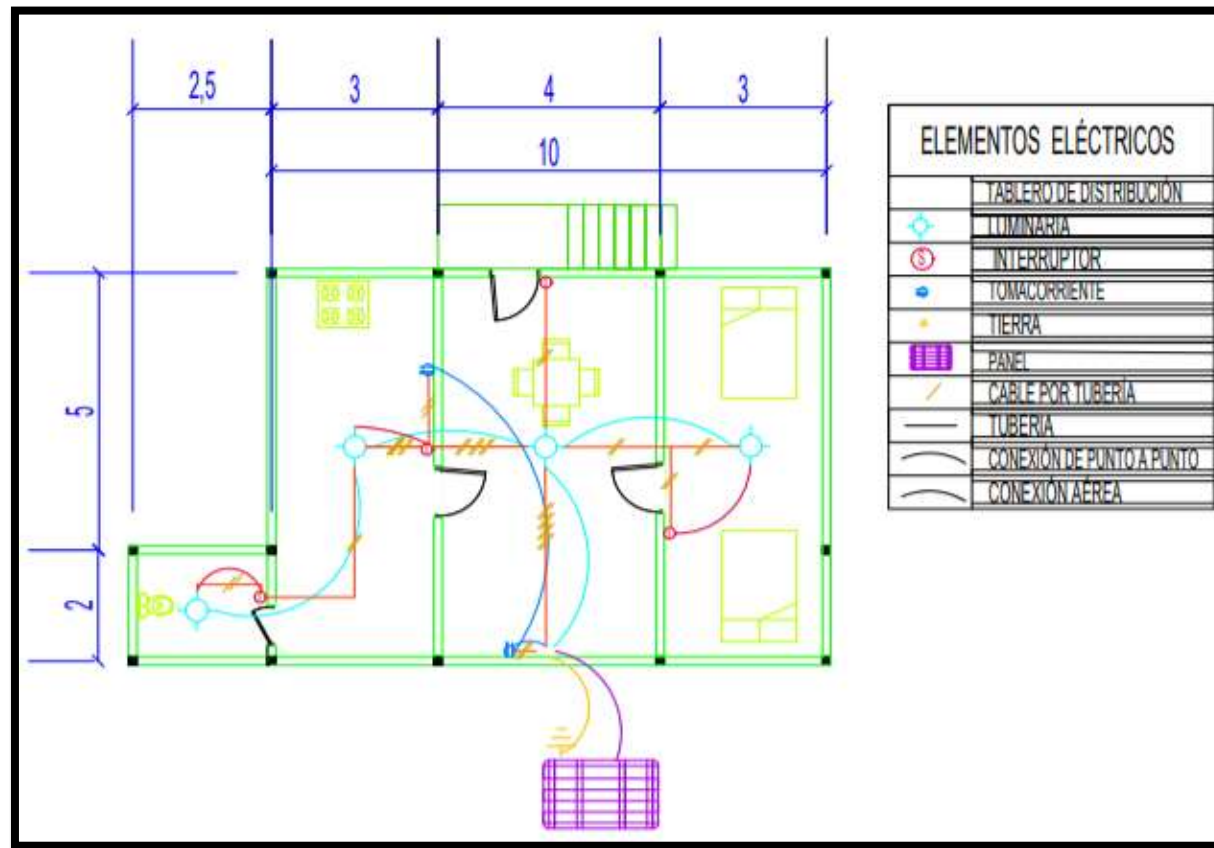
Plano eléctrico de la vivienda beneficiada, fuente: Autores.
